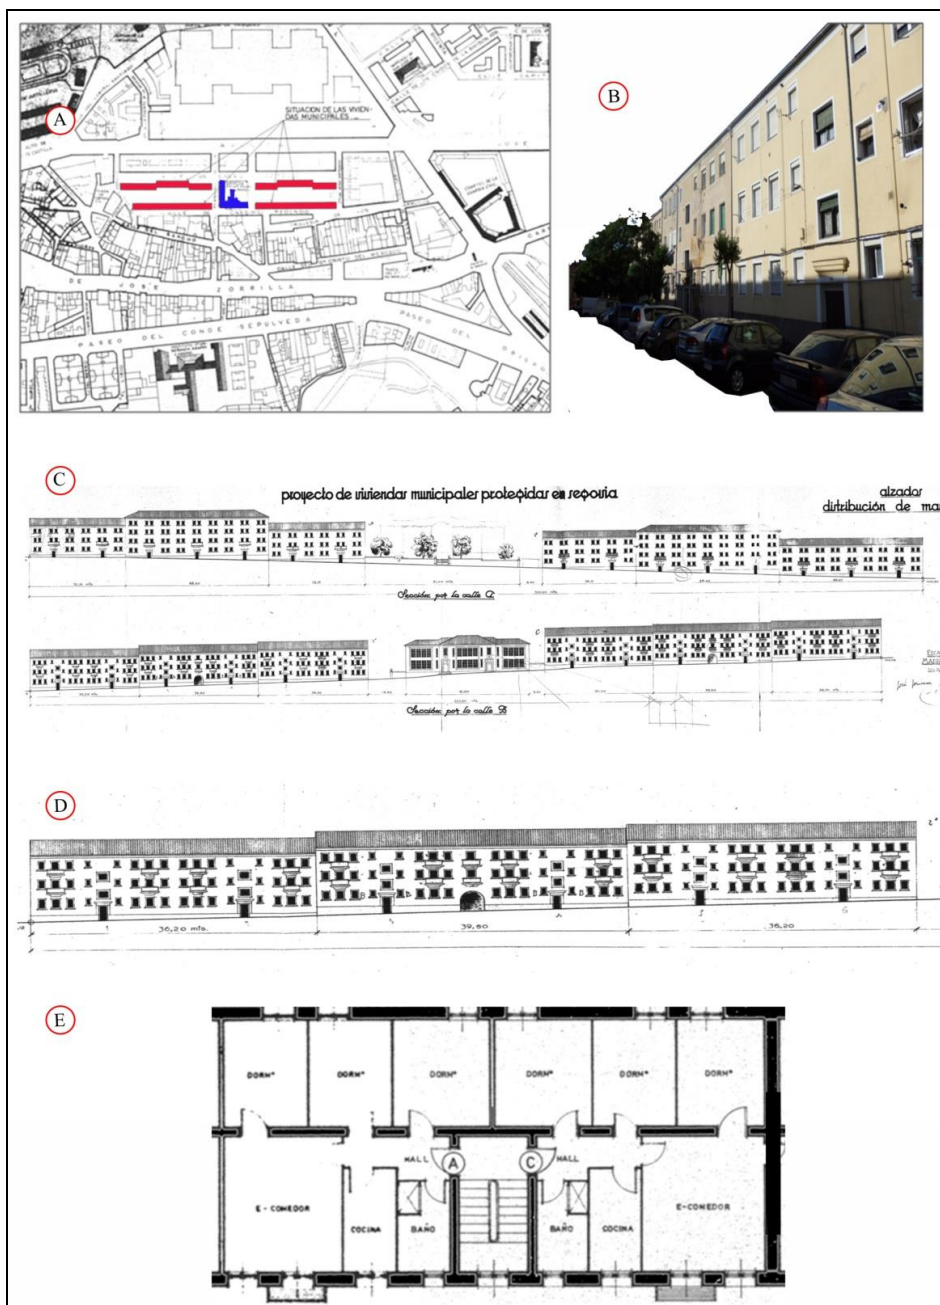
Viviendas municipales y grupo escolar: a) Plano de situación, en rojo viviendas y en azul grupo escolar; b) situación actual; c) Alzado de conjunto; d) ampliación del alzado de un bloque de viviendas; y e) planta tipo de viviendas. (Fuente: elaboración propia)
